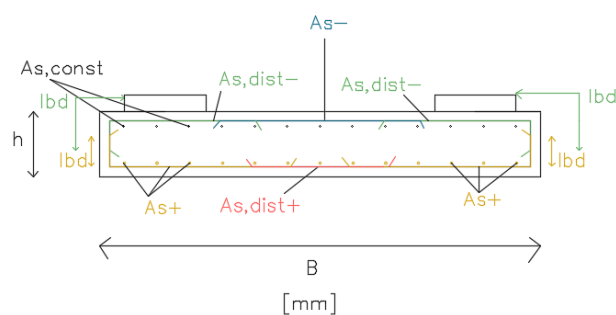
Pormenor da disposição construtiva da armadura longitudinal nas fundações A, B, C e D
